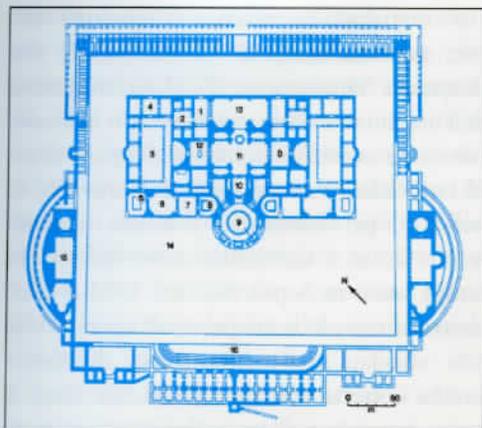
Terme di Caracalla: planimetria (da Coarelli 1984)
